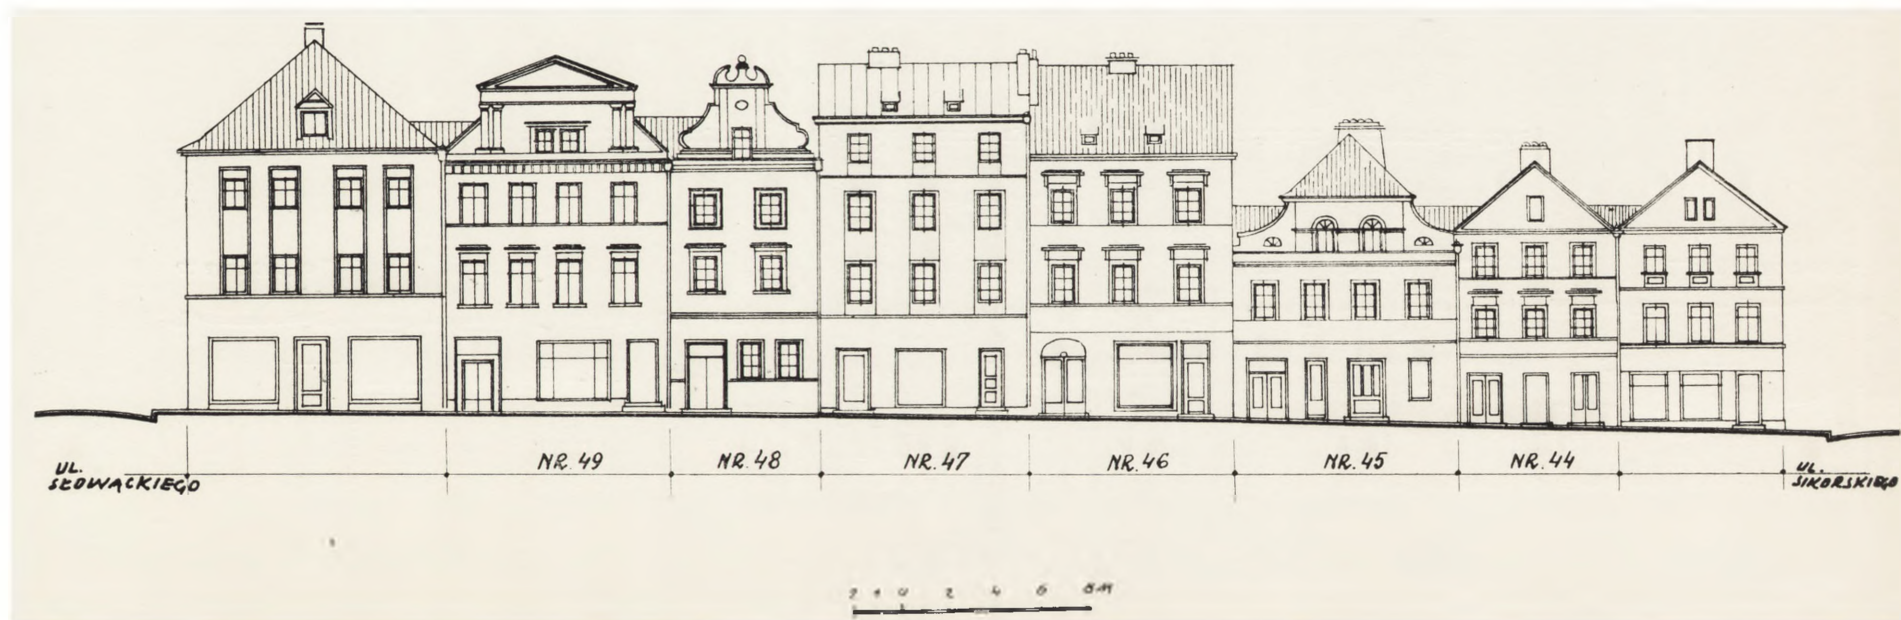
Paczków, inwentaryzacja płd.-zach. pierzei rynku (rys. Politechnika Warszawska, ZAP)
